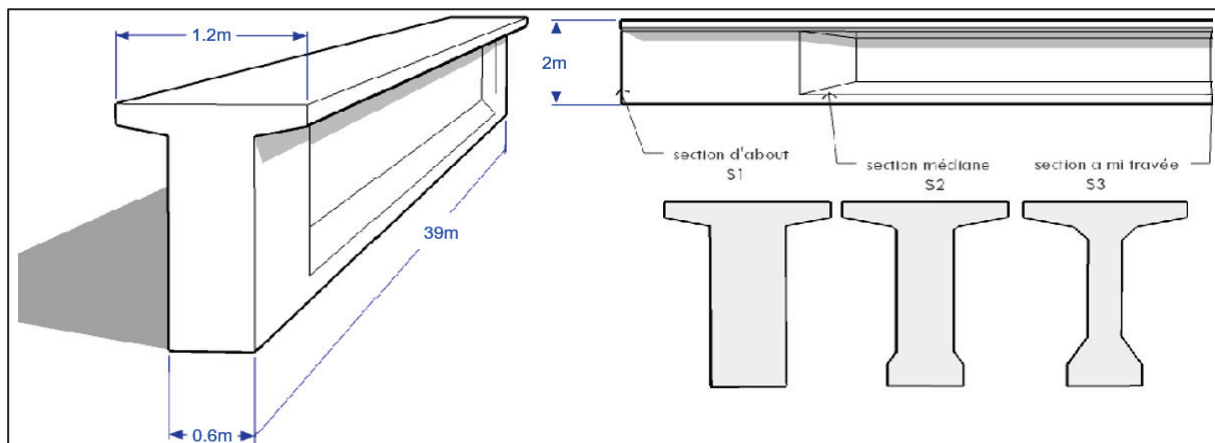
LES DIMENSIONS DES POUTRES.
